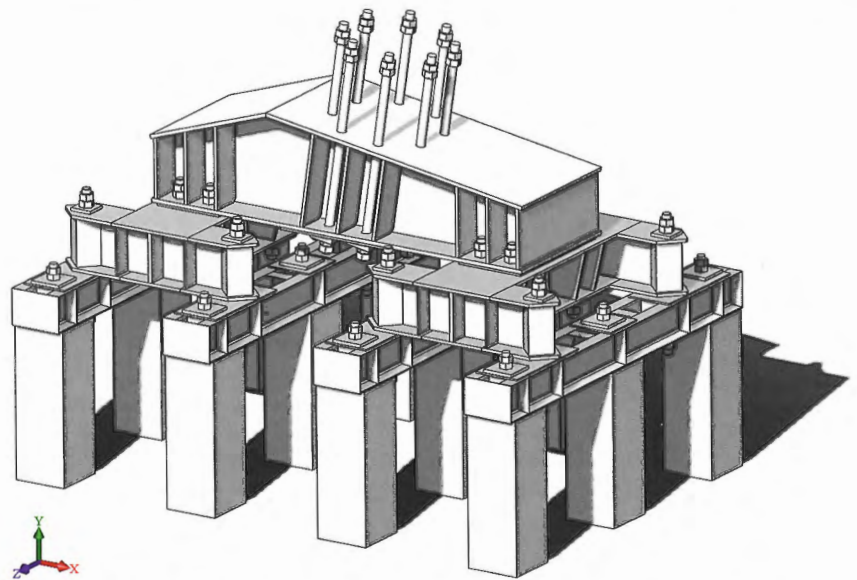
Фундамент из составных железобетонных свай с металлическим ростверком на переходе ВЛ 220 кВ через Волгу в районе Балаково
